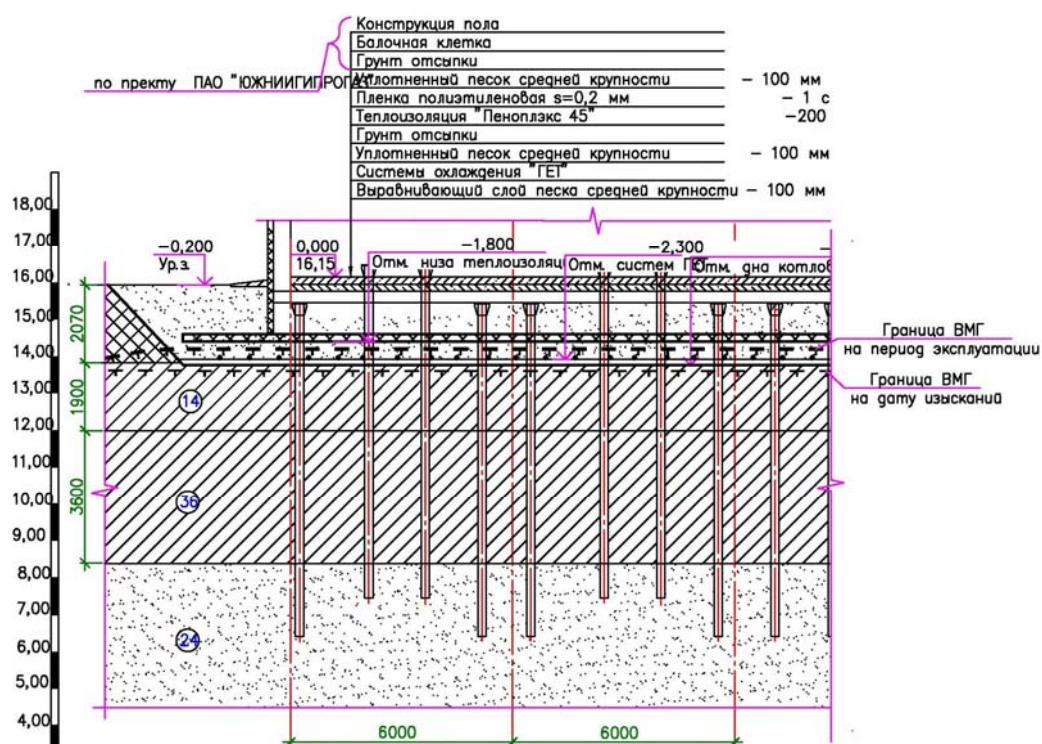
Здание на охлаждаемом основании системой ГЕТ с полами по грунту.
